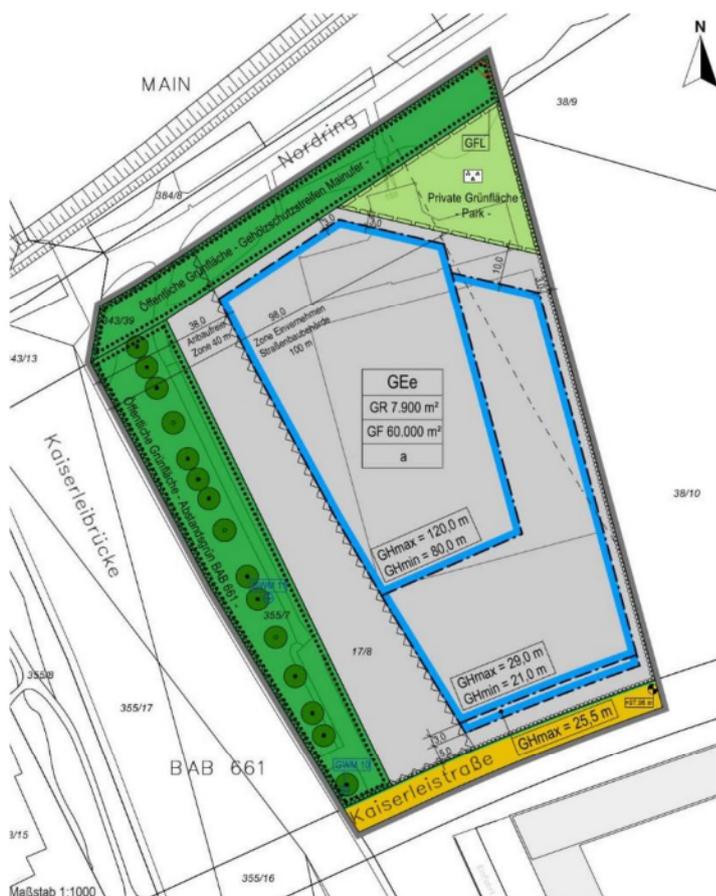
Entwurf des Bebauungsplans Nr. 652 A
